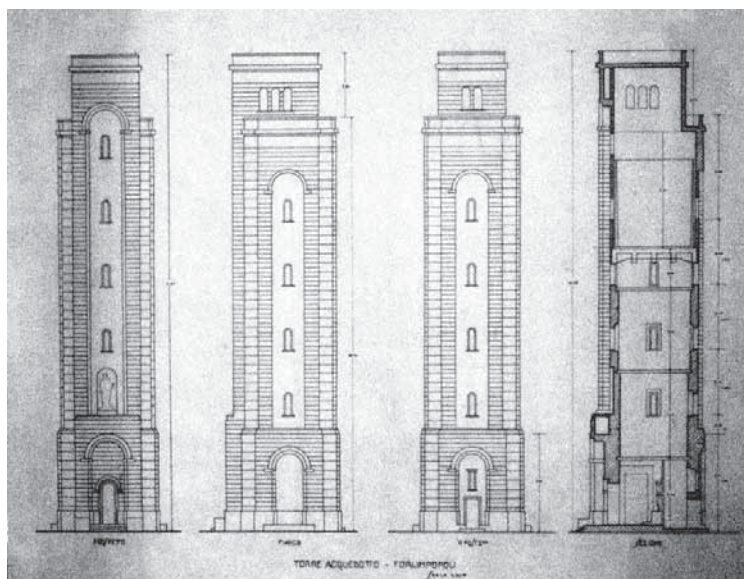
P. NOVAGA, 2° progetto di torre serbatoio (realizzato) con prospetto posteriore e sezione (Archivio privato C. Maltoni)
